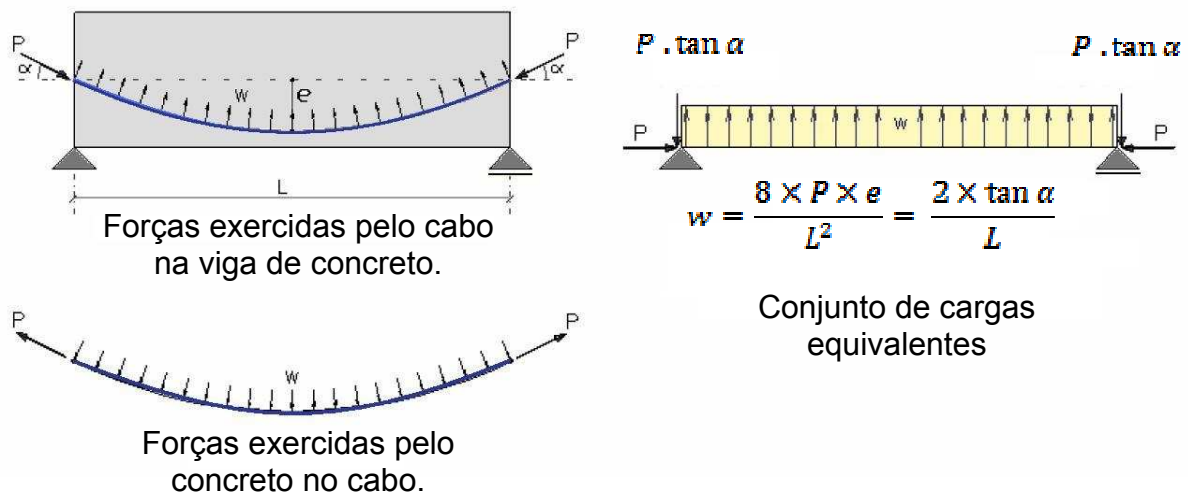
Esquema da viga de concreto com o cabo de protensão
